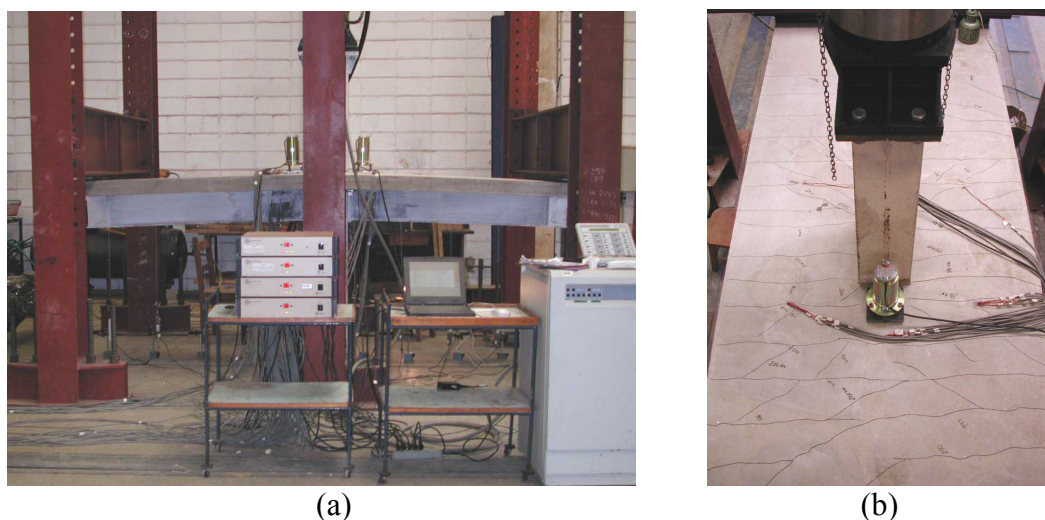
Modelo misto no estágio final do carregamento e fissuras sobre a laje
